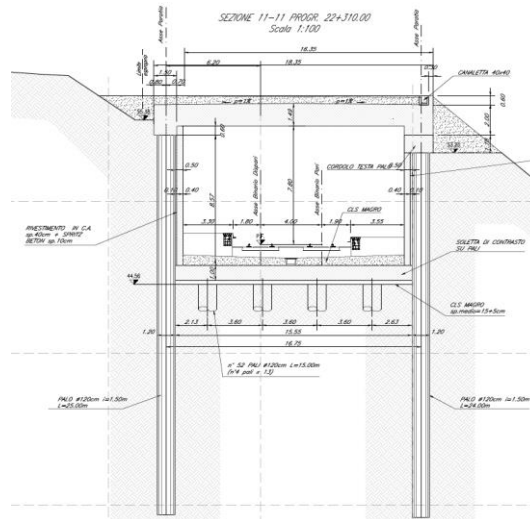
Sezione trasversale rappresentativa della geometria della sezione GA02_F2 (pk 22+308)
